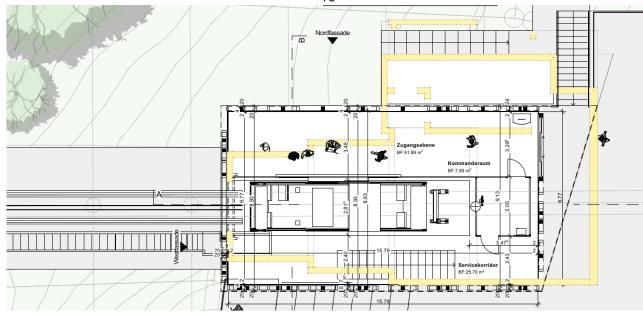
Grundriss geplante Bergstation mit ebenerdigem Ein-/Ausstieg
